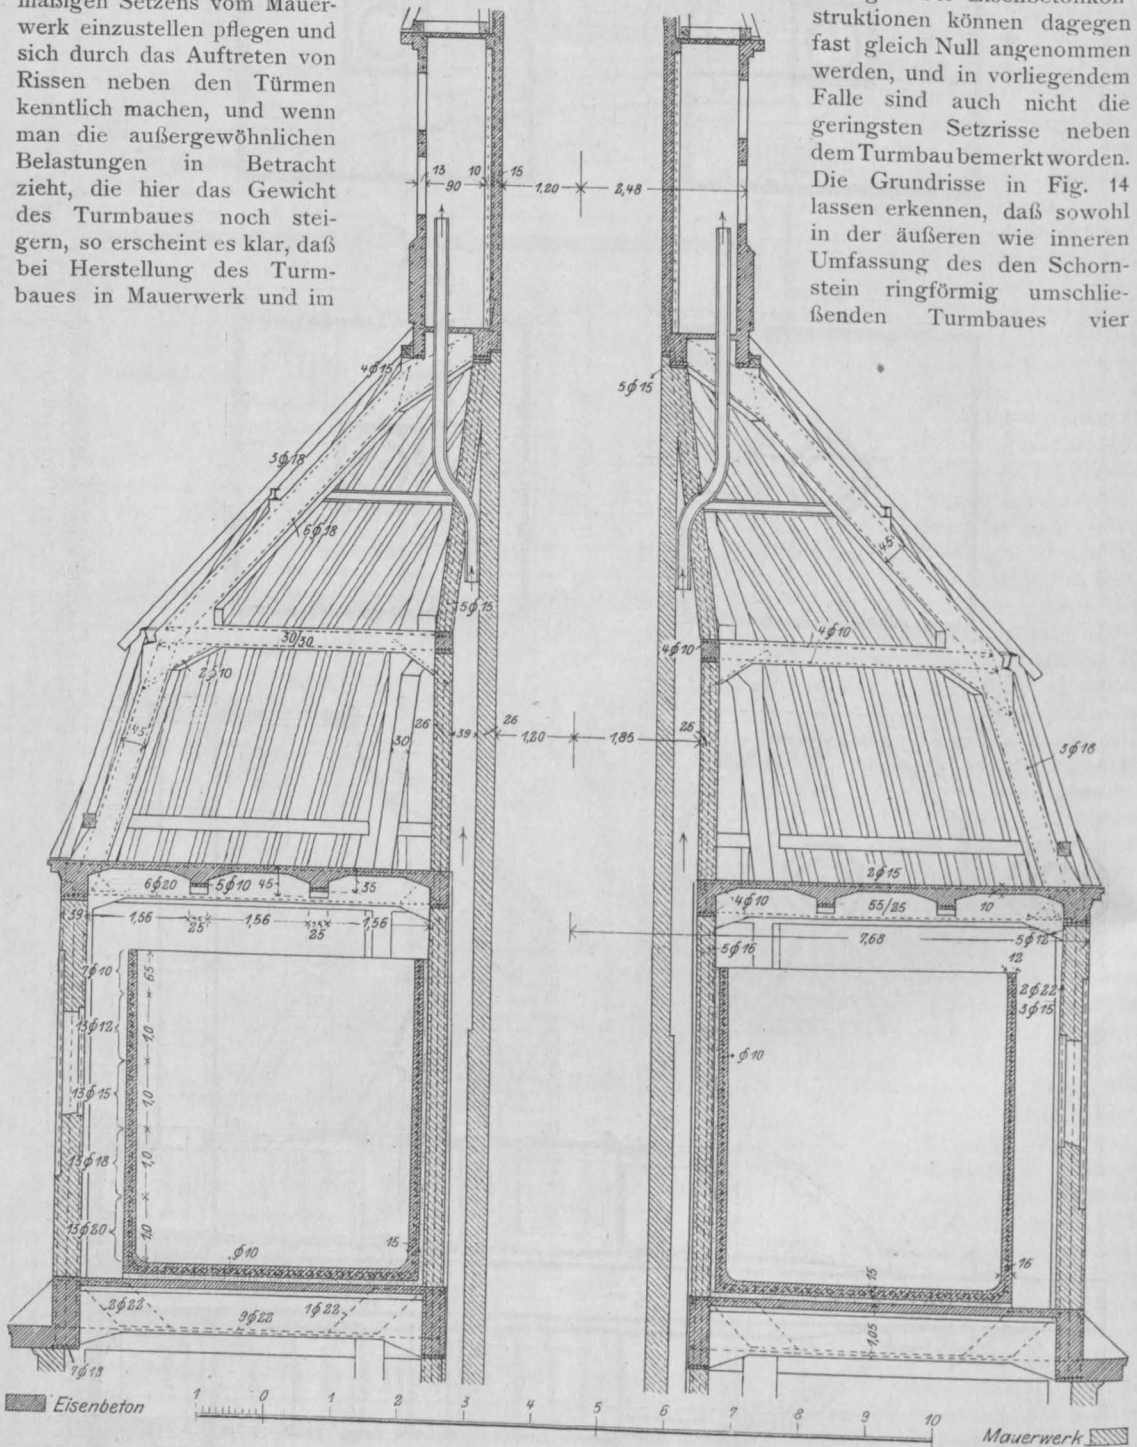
Sechstes Geschoß und Dachgeschoß vom Turmbau.
